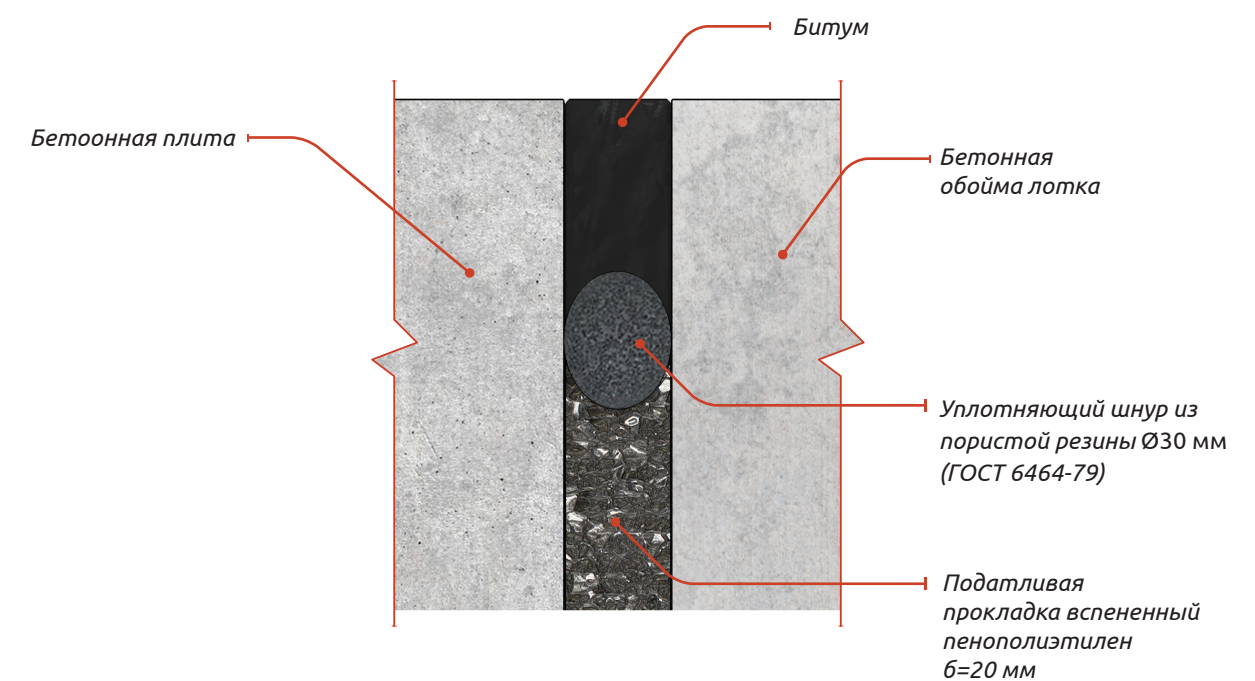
Узел примыкания обоймы лотка к бетонному покрытию.
